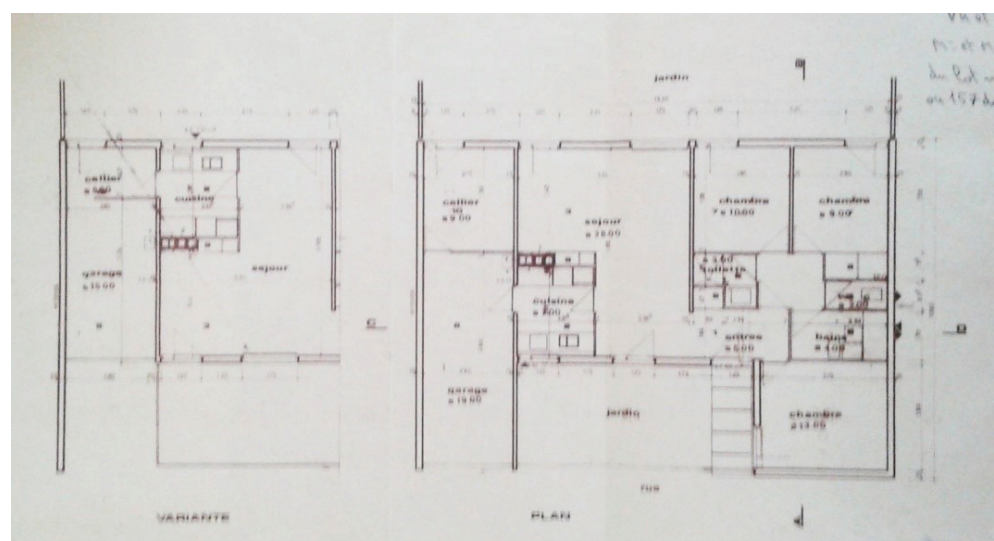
Plan d'une villa T4 mitoyenne de part et d'autre. Hameau de Noailles
